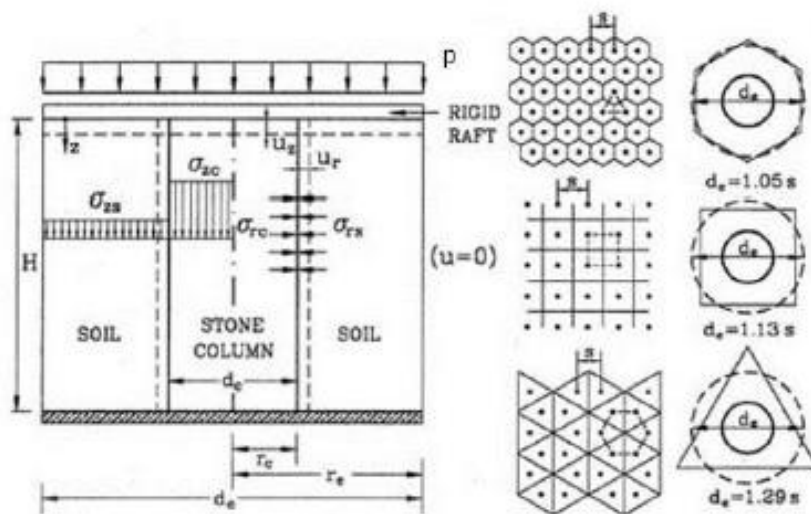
Disposiciones de las columnas de grava en planta. suelos blandos bajo diques s. Balaam &Brooker(1981).
